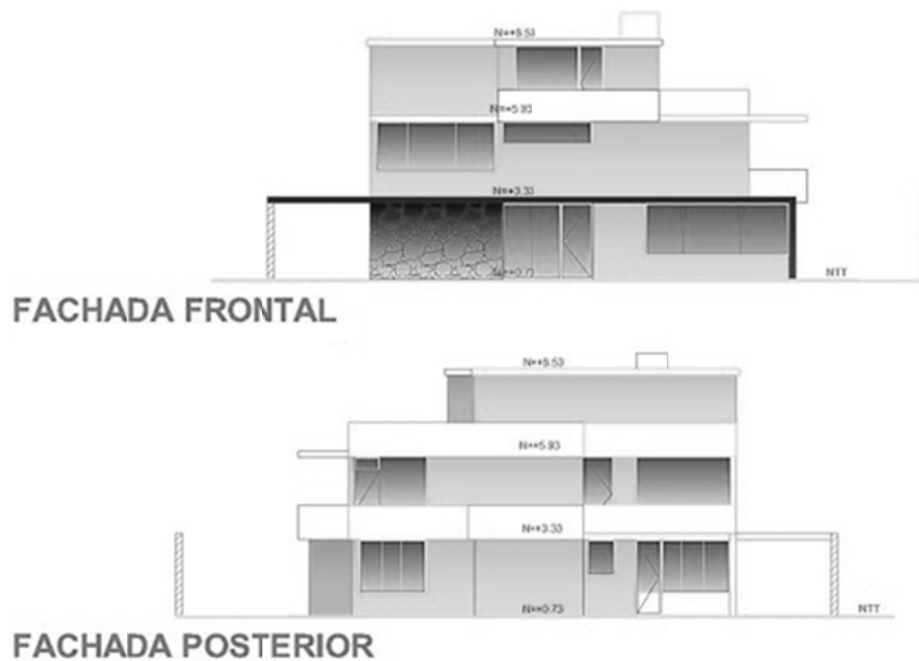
Fachadas actuales de casa Av. 12 de Octubre
